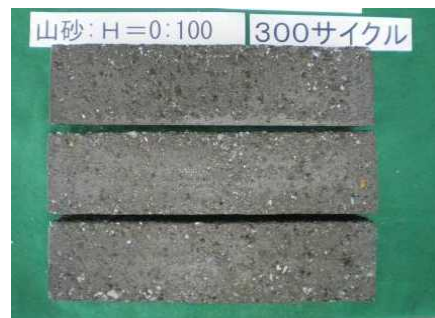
凍結融解試験の状況 (No. 4 300 サイクル)
